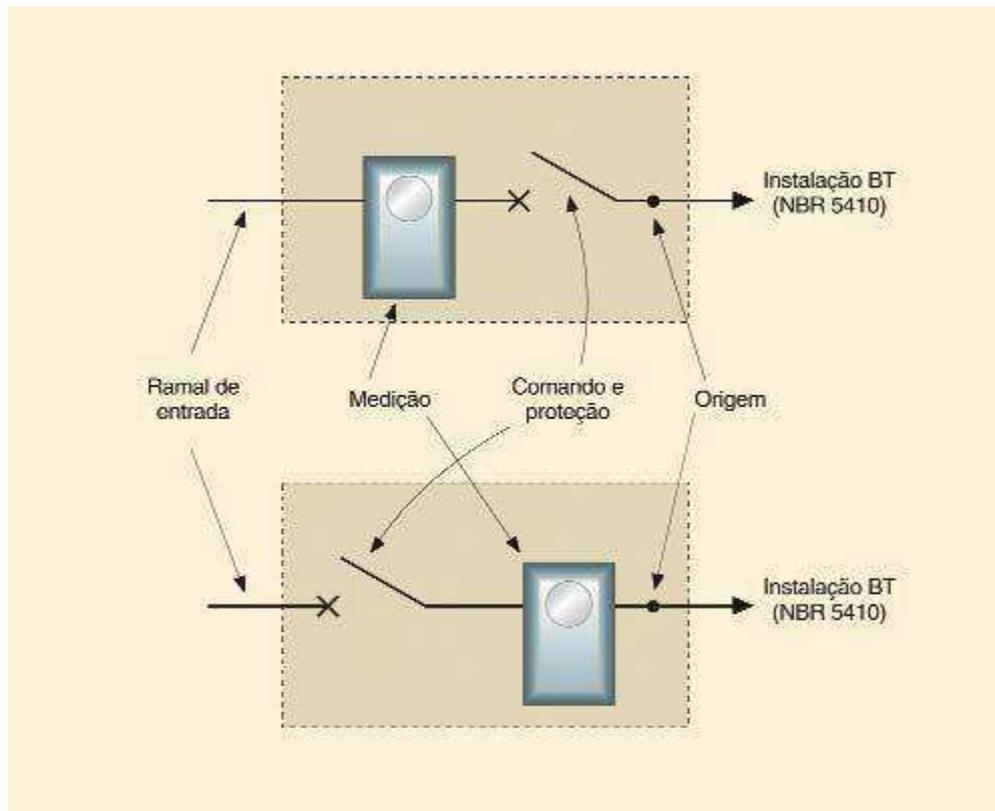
Origem de instalação alimentada diretamente em baixa tensão.
